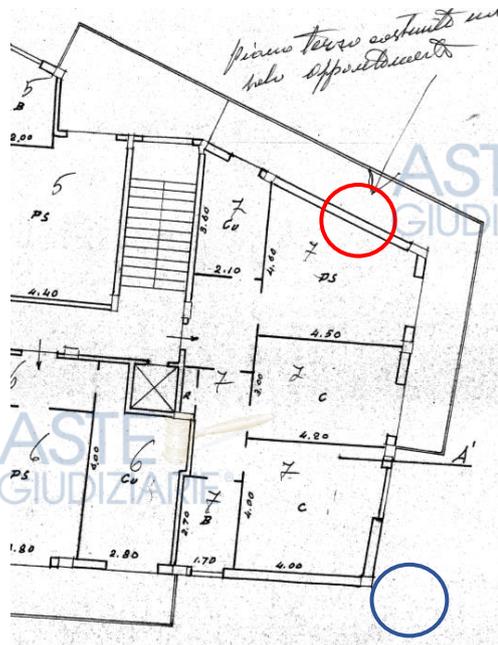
Pianta piano tipo Licenza Edilizia 59/1972.
